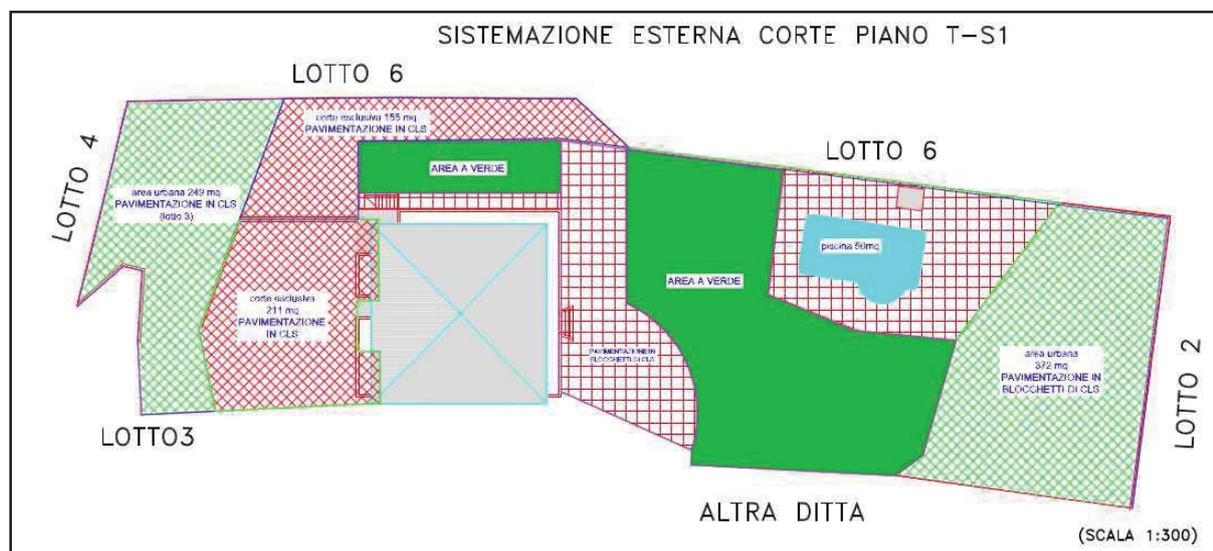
Sistemazione esterna generale piano T LOTTO 1
